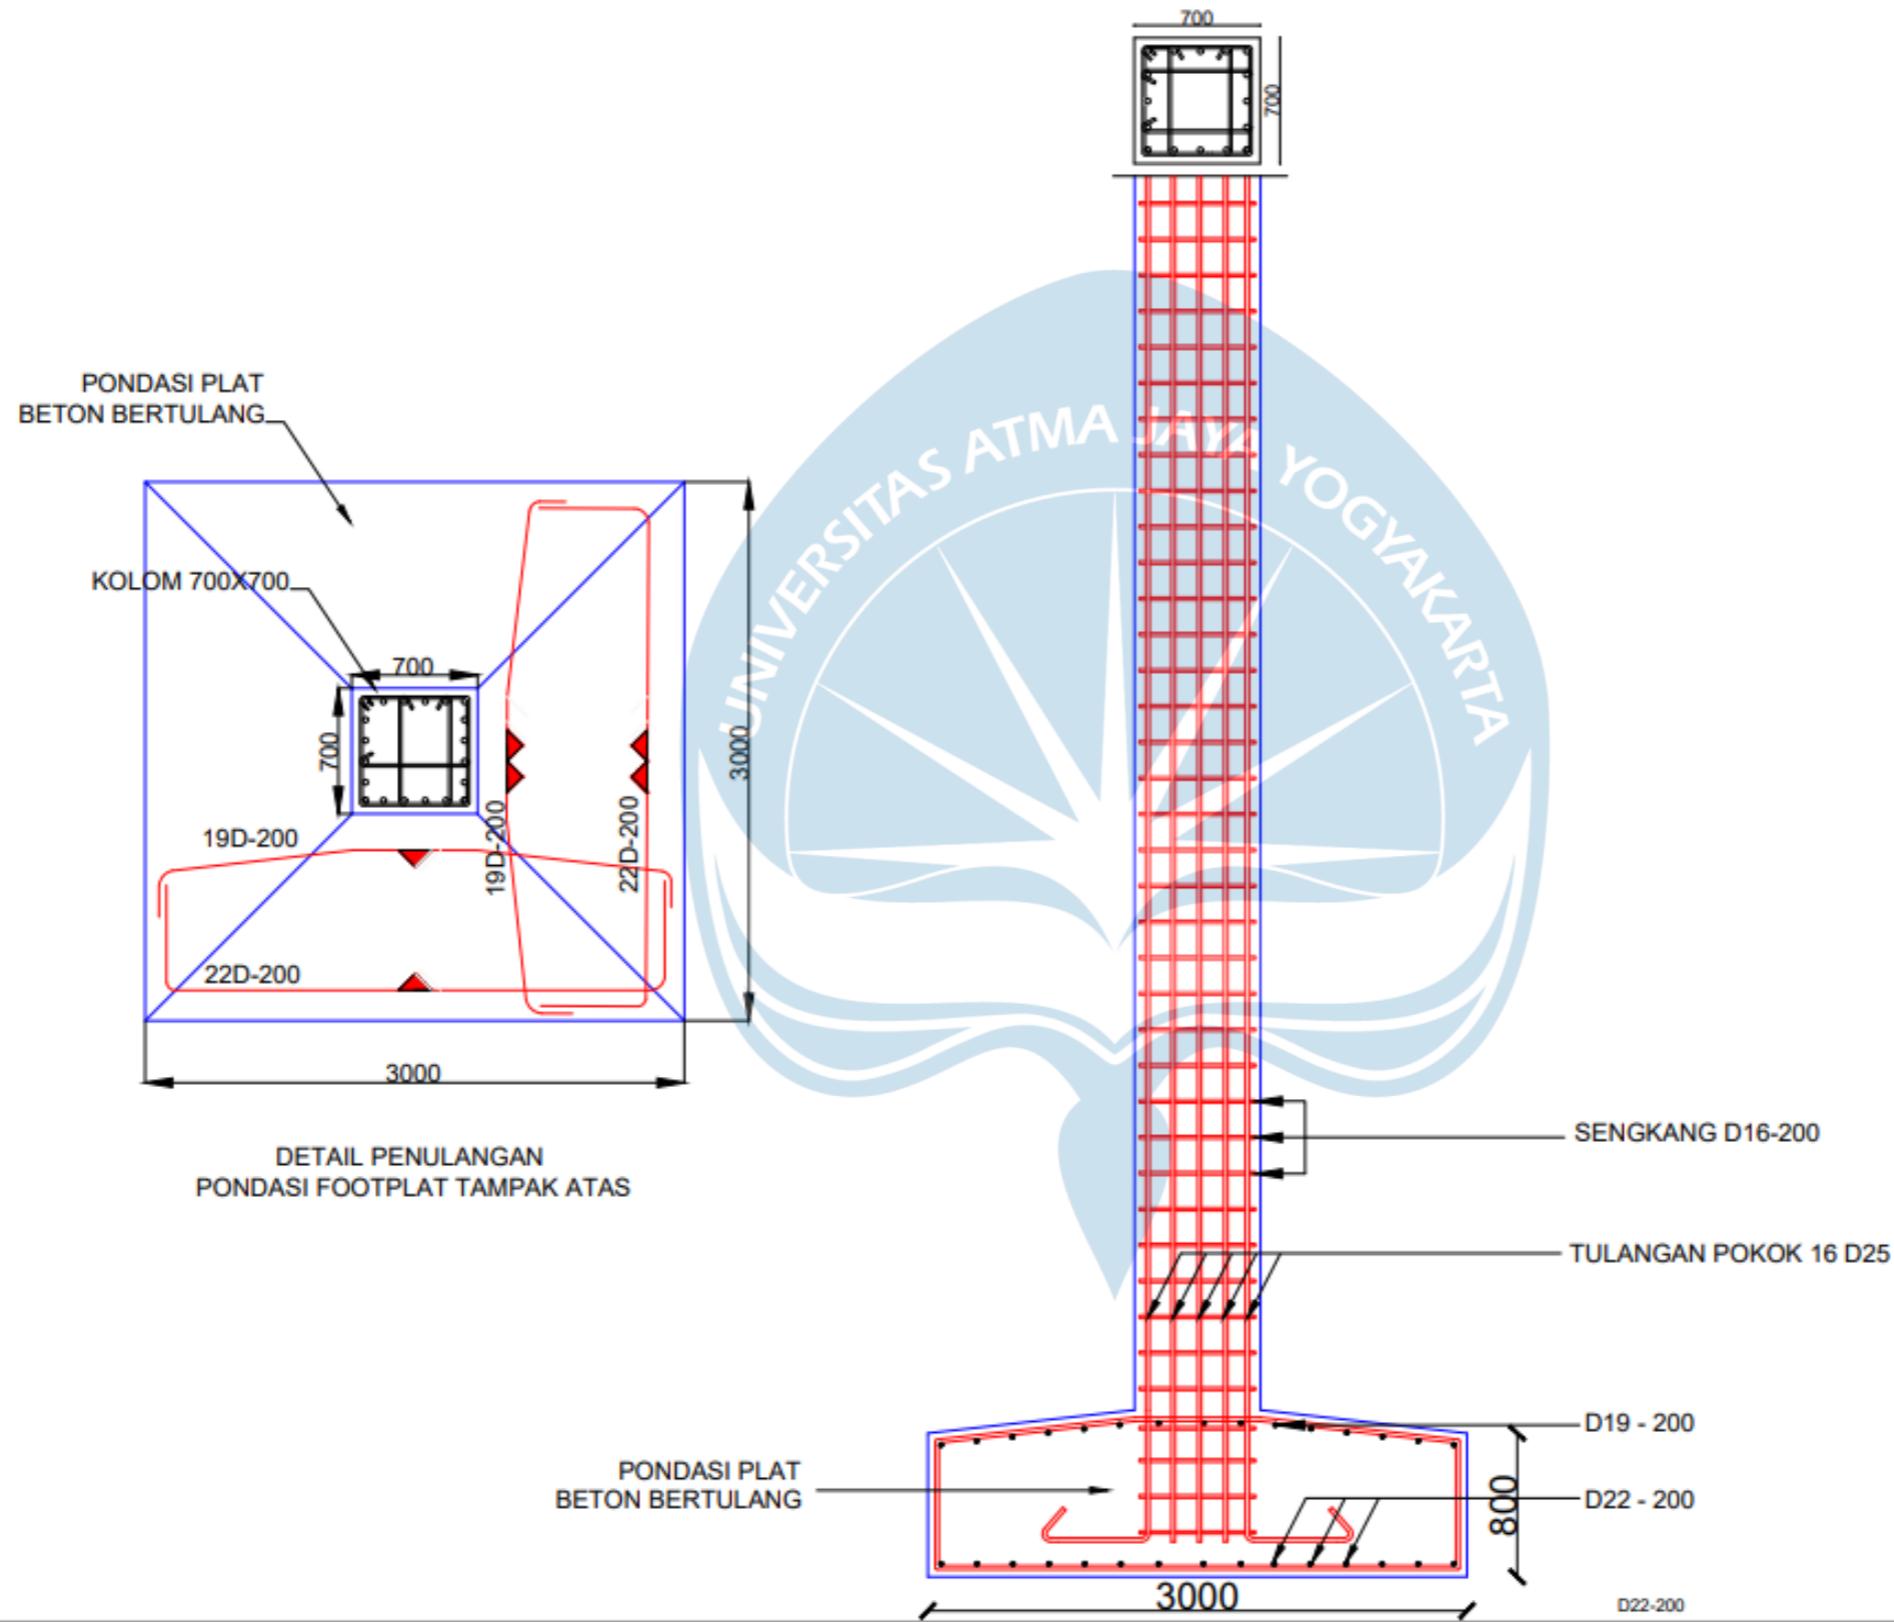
DETAIL TULANGAN FONDASI FOOTPLAT 5X5
